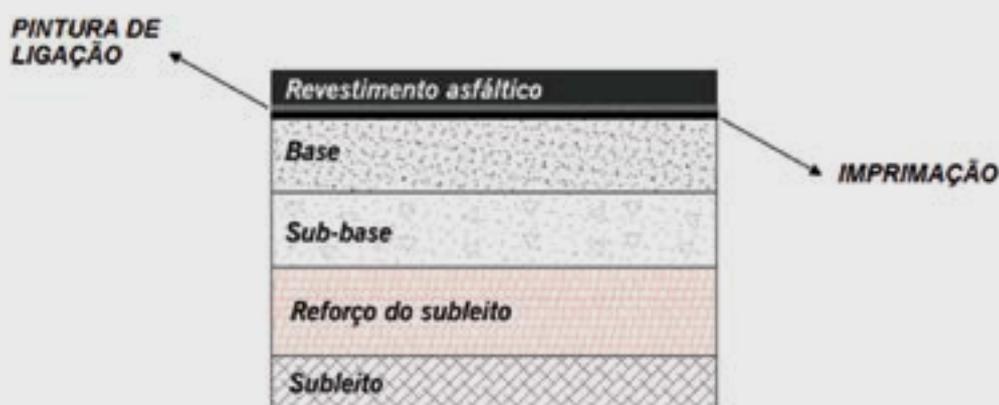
Estrutura típica de um pavimento asfáltico^[1]
